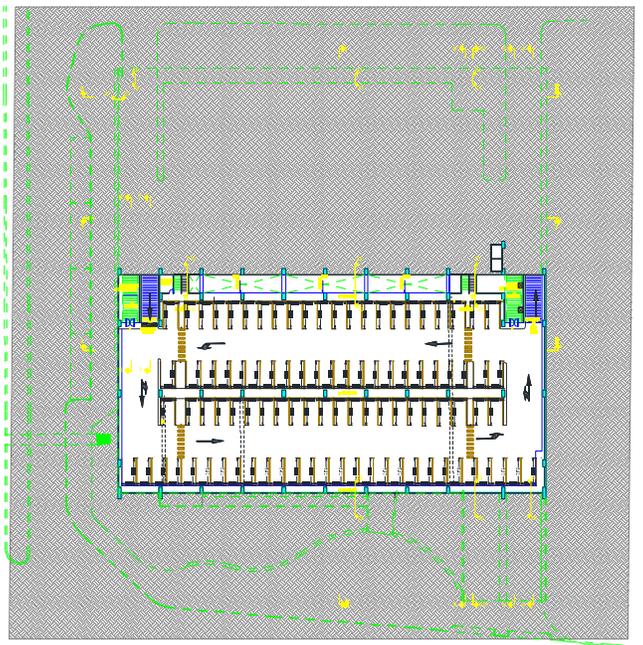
Planta Nivel 1. N+0.00 y N+1.80
